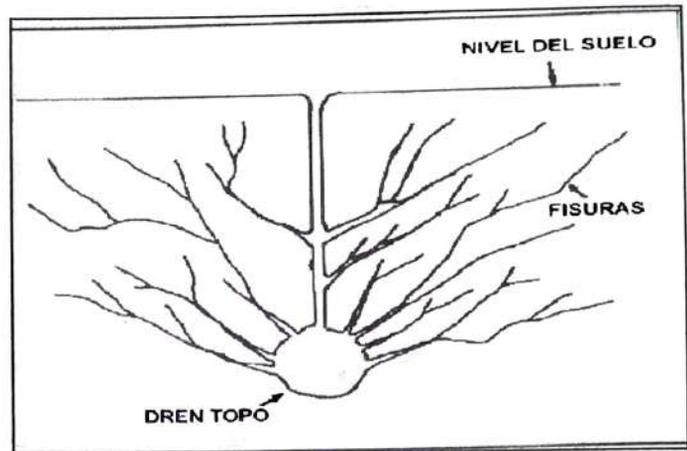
Drenes topo. (Fuente: Jerez y Ortega, 1996)
